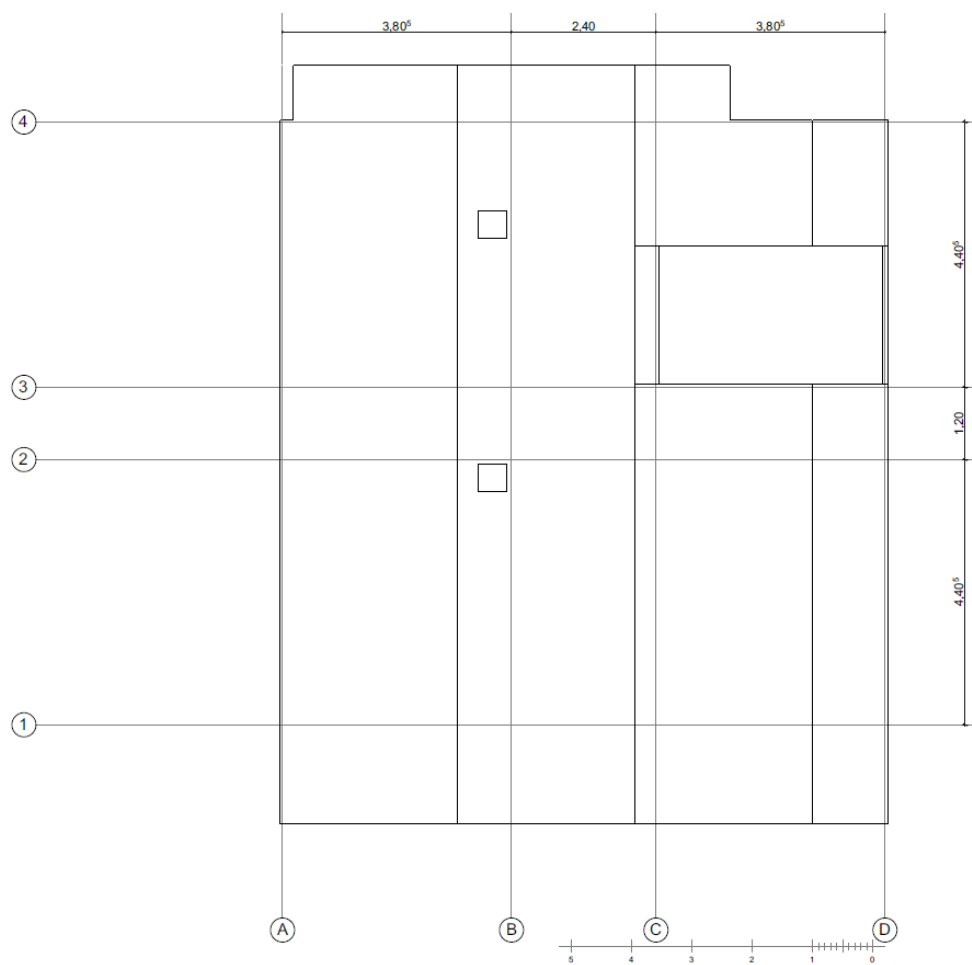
Planta do pavimento do Piso 1, mostrando a distribuição das juntas dos painéis.
